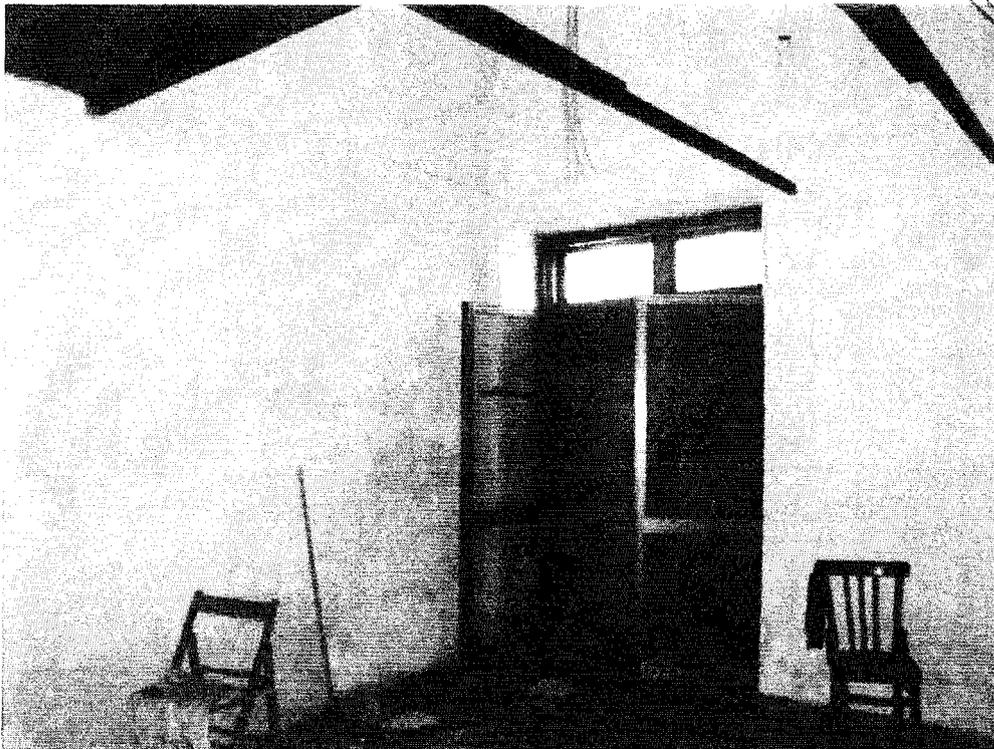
vista dall'interno del cospite dell'accesso allo stesso da Via Duca degli Abruzzi; quest'altro varco costituisce la seconda ed ultima fonte di illuminazione ed aerazione diretta dell'immobile
